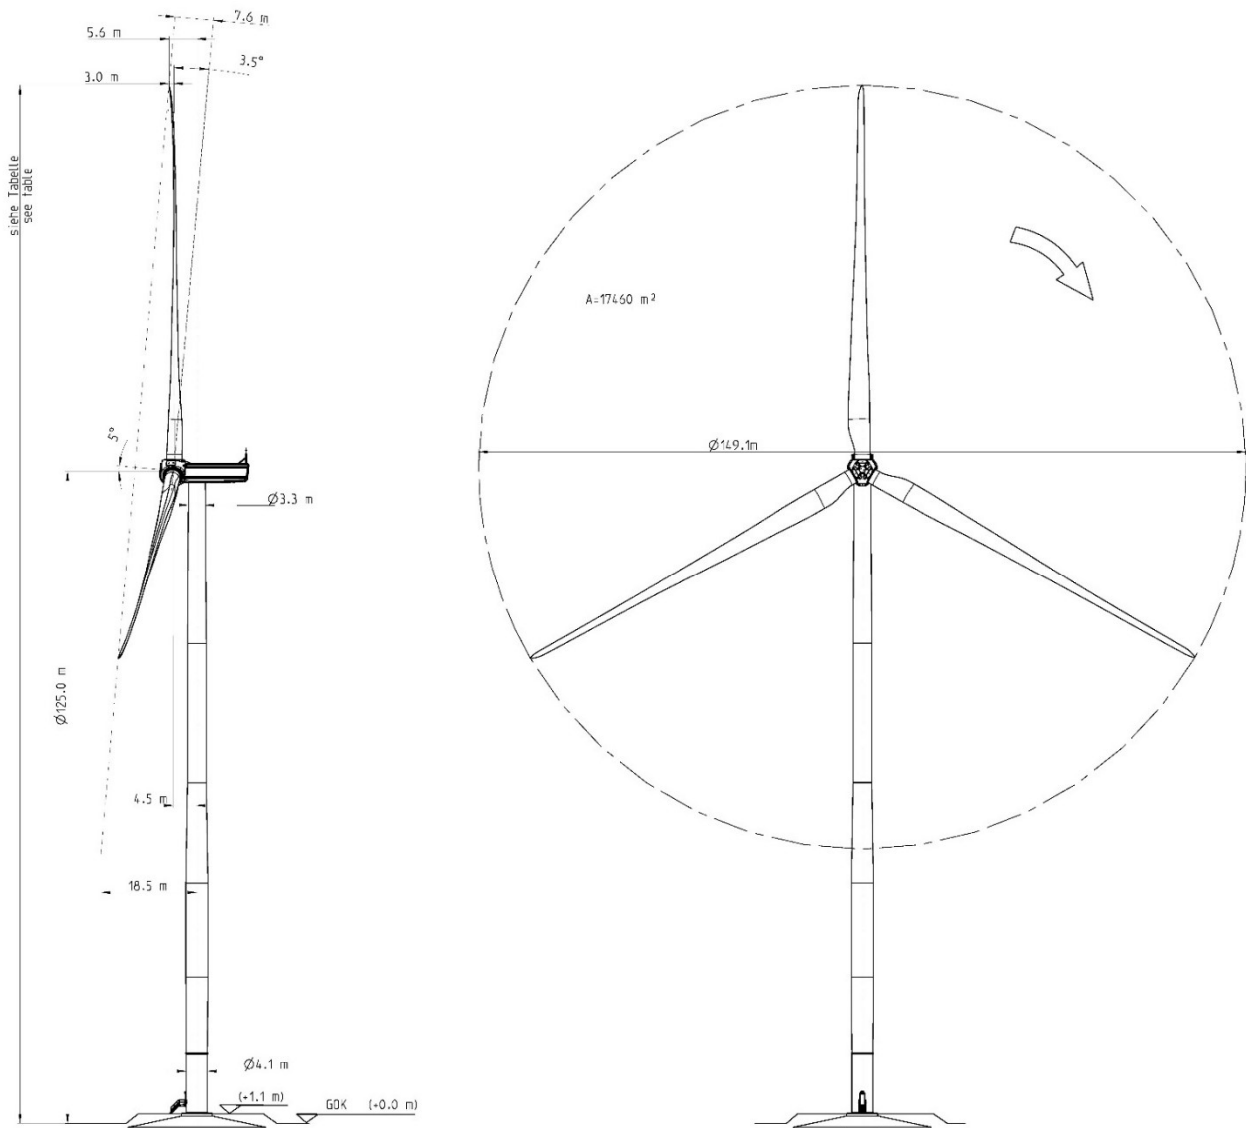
Plan d'élevation de l'éolienne N149 – 4,5 MW – 200m (Source : Nordex)
